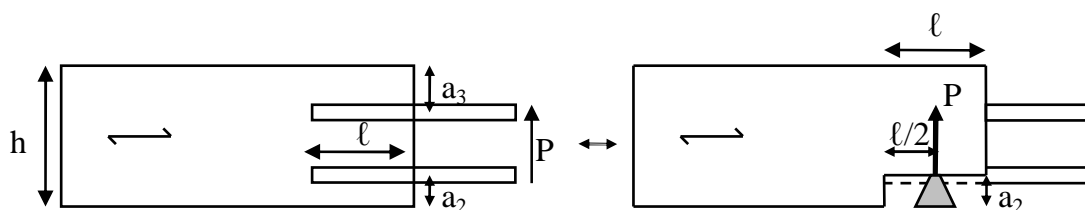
Correspondance assemblage collé et poutre entaillée pour des goujons collés insérés parallèlement au fil du bois et chargés latéralement.
